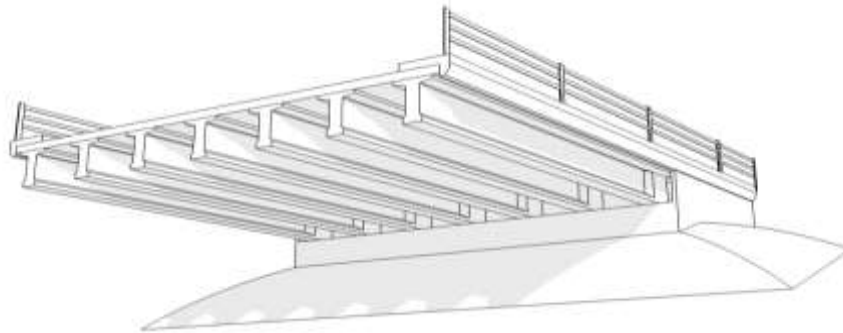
Morphologie générale d'un pont à poutres en béton précontraint
